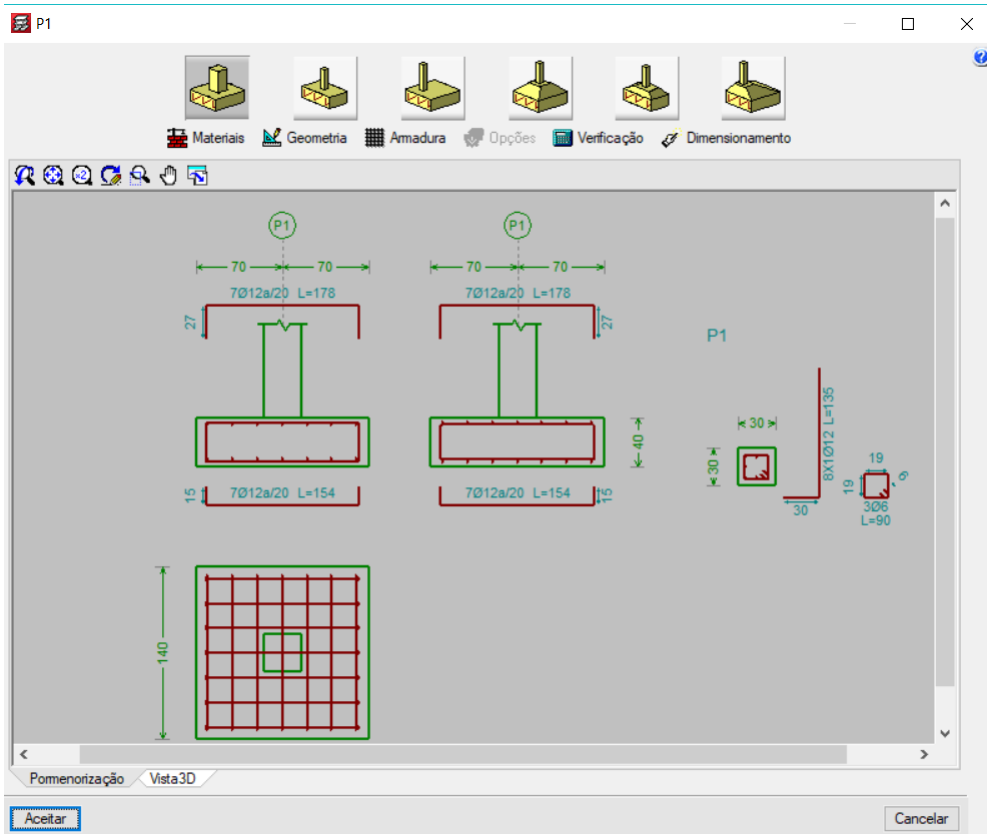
Solução de armaduras para a sapata do pilar P1
